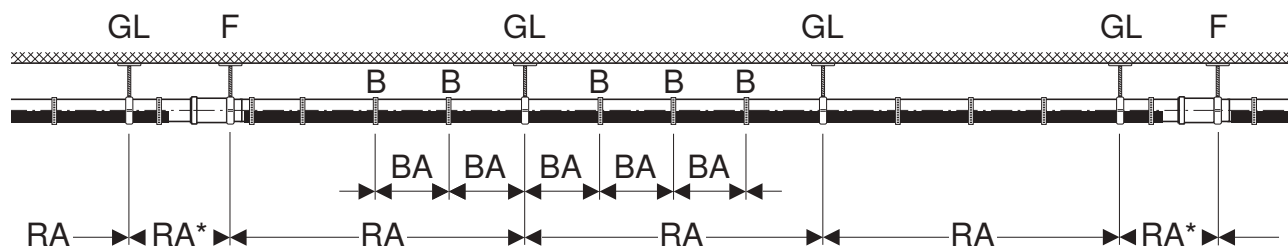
Distances entre les colliers RA en cas de fixation à des plafonds et des murs, avec coques
